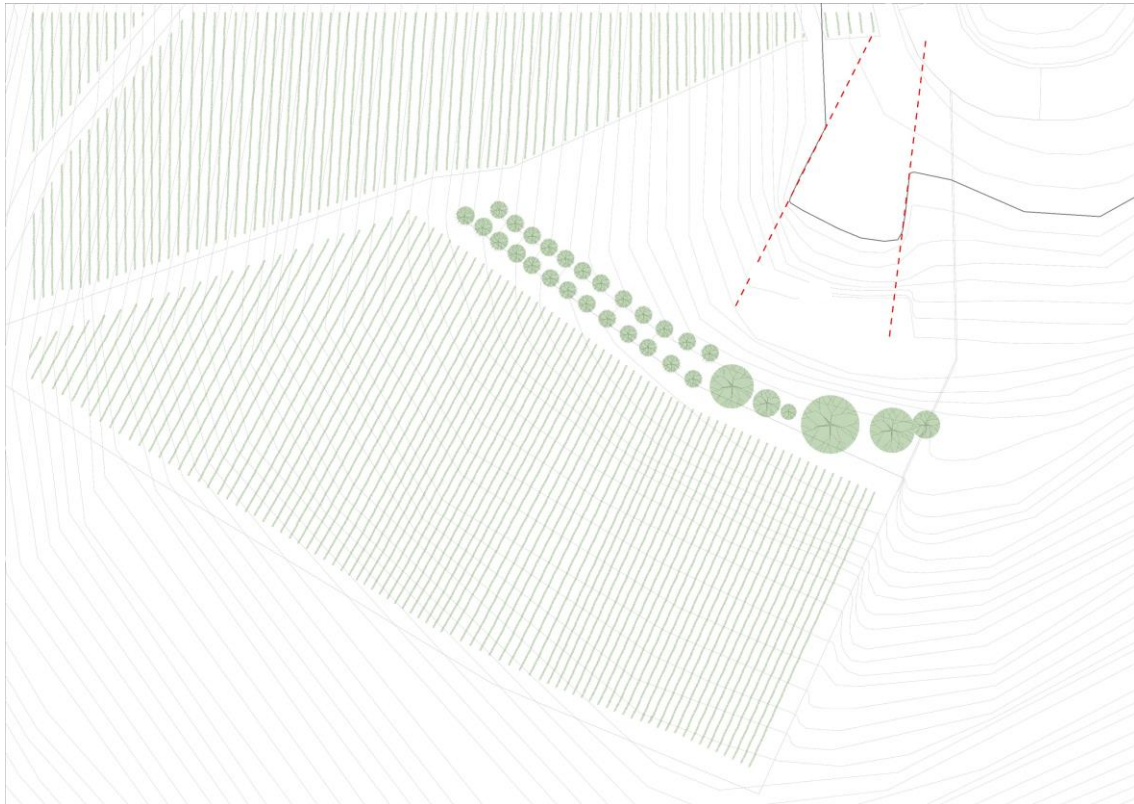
Planta de implantação e diretrizes que delimitam a forma do projeto – Autor.
